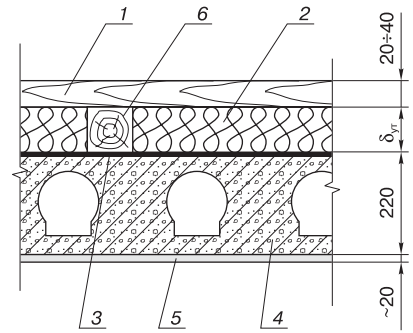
Утепление чердачного перекрытия из многоспустотного настила изделиями «URSA»: 1 – деревянный настил; 2 – теплоизоляционные изделия «URSA»; 3 – пароизоляция; 4 – плита перекрытия; 5 – потолок; 6 – лаги
